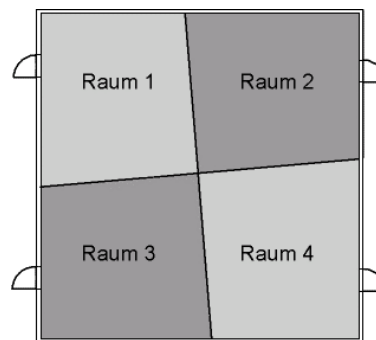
Grundriss eines Kubus mit schräg gestellten Innenwänden.
